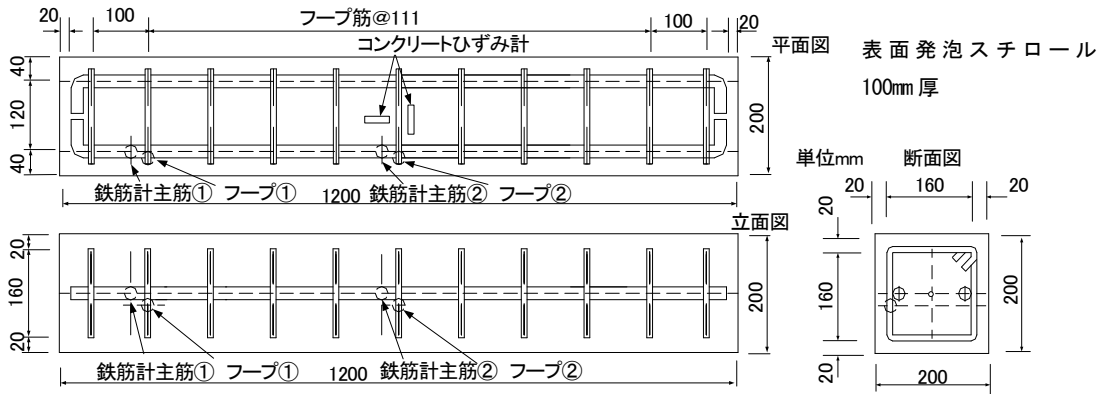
RC 試験体と計測器位置 No. 1、No. 2 試験体
